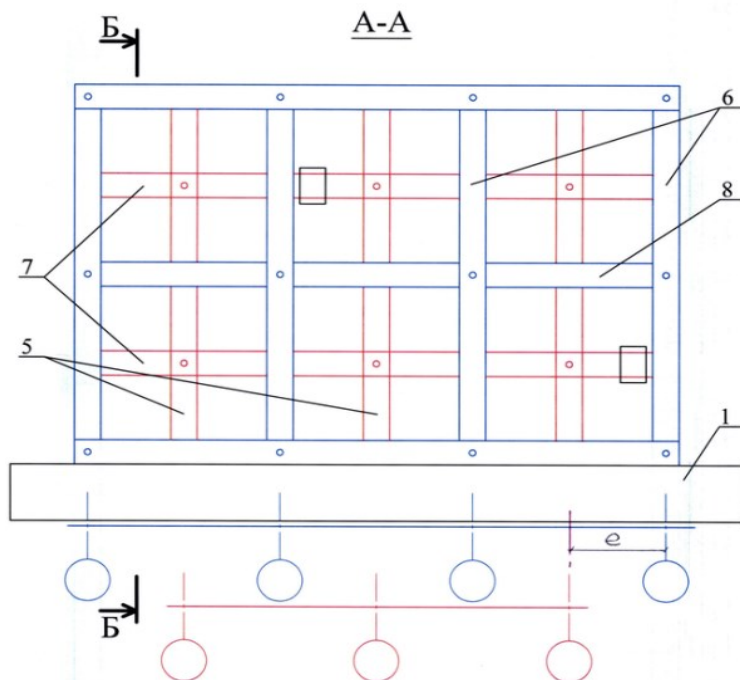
Вид А на фрагмент сечения наружной стены здания [3] (рис. 4):
